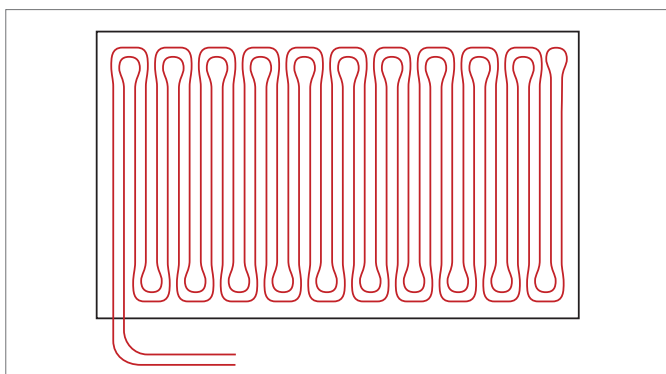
Sistema de techo radiante para refrescamiento/calefacción REHAU
